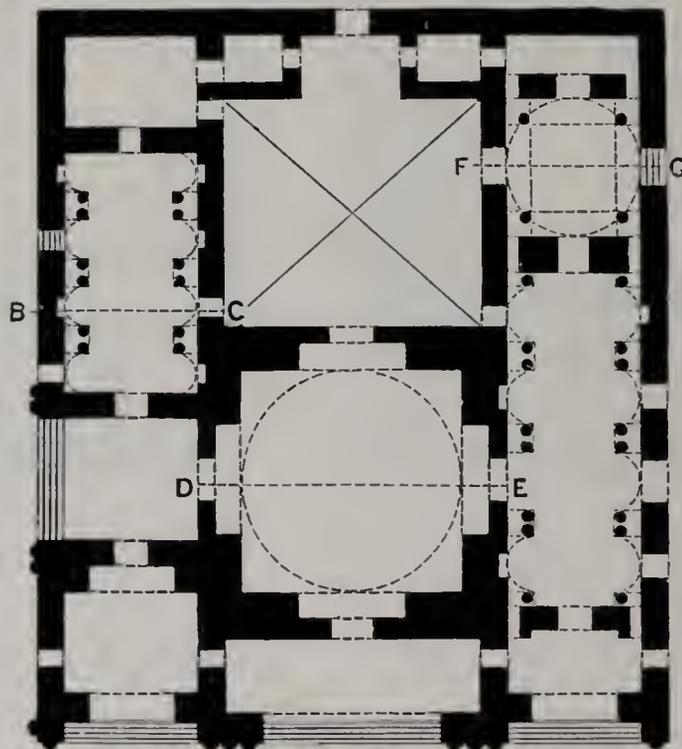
Palast zu Sarvistan. Grundriß. (Nach Phené Spiers.)
